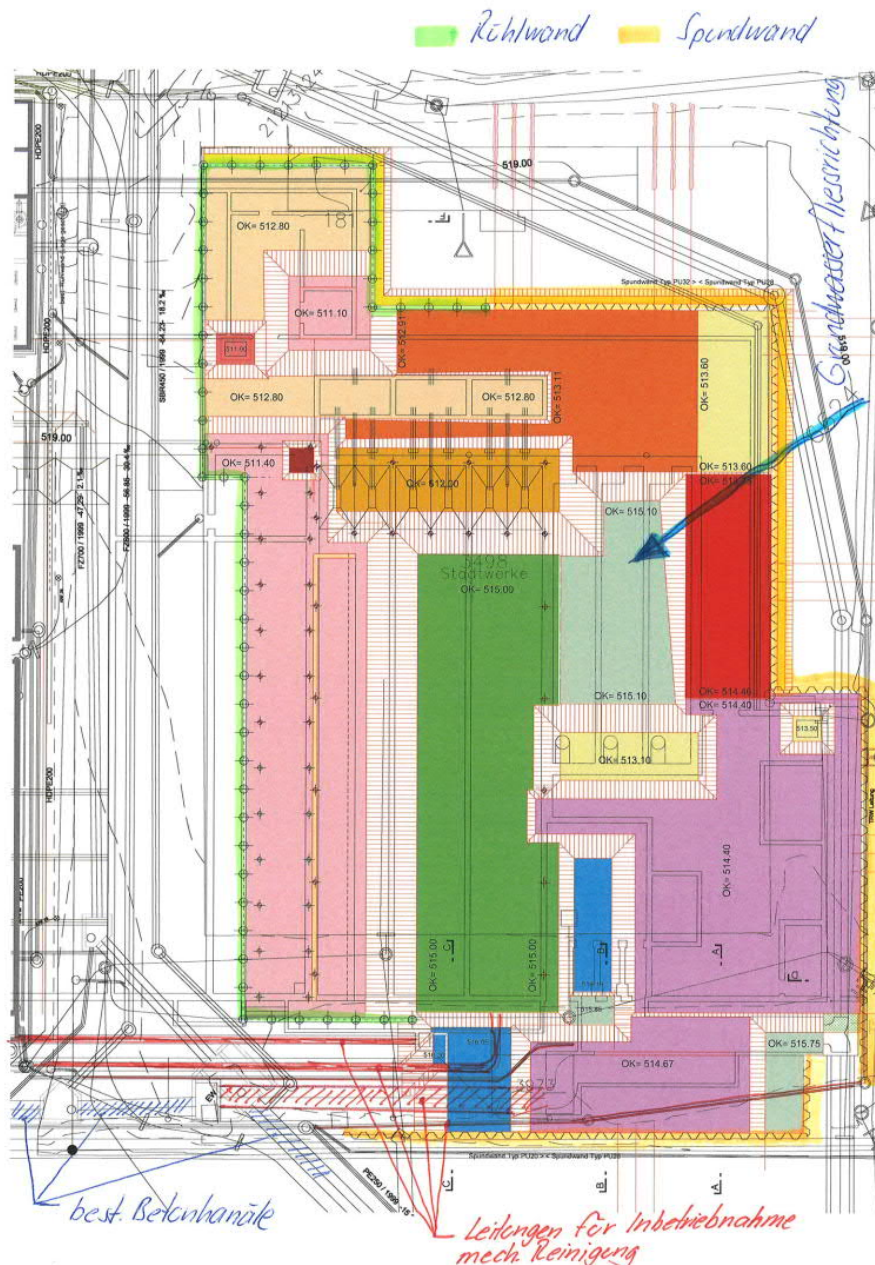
Baugrube Etappe 2c; Grundriss Baugrube
